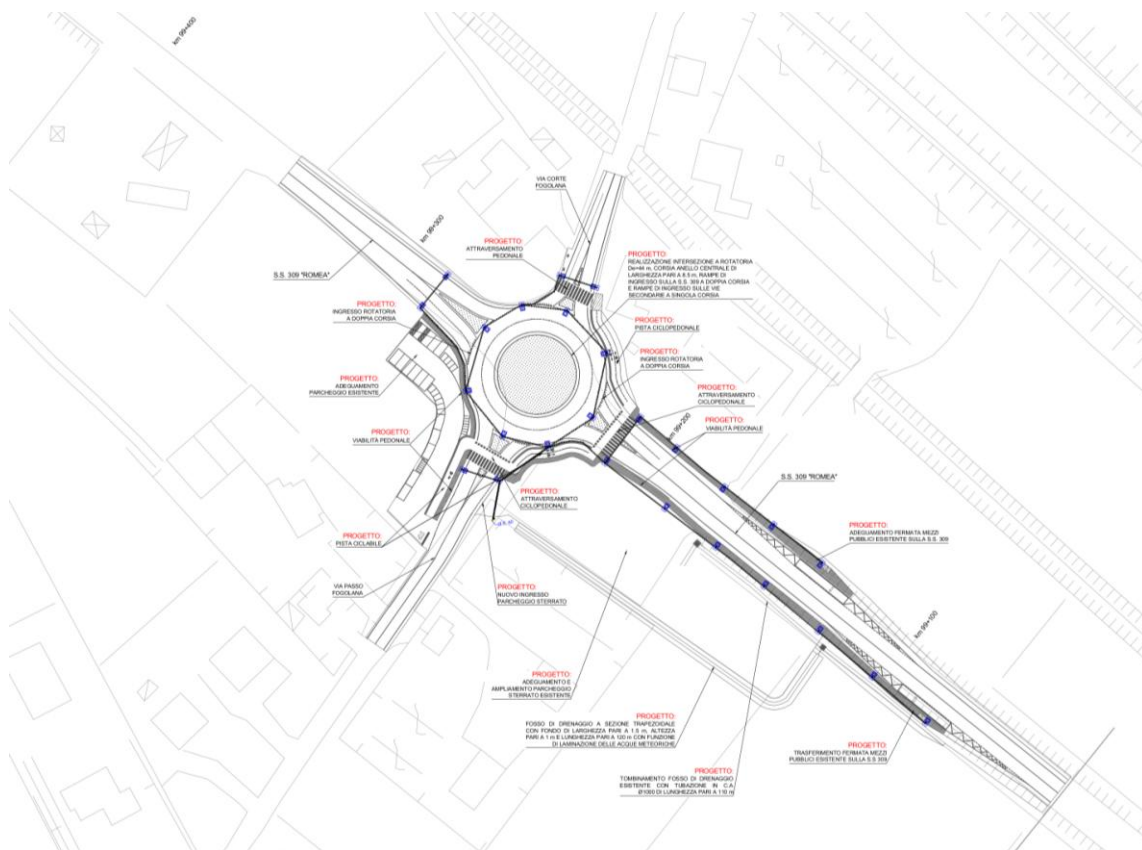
Posizionamento dell'opera nell'area oggetto dell'intervento.
